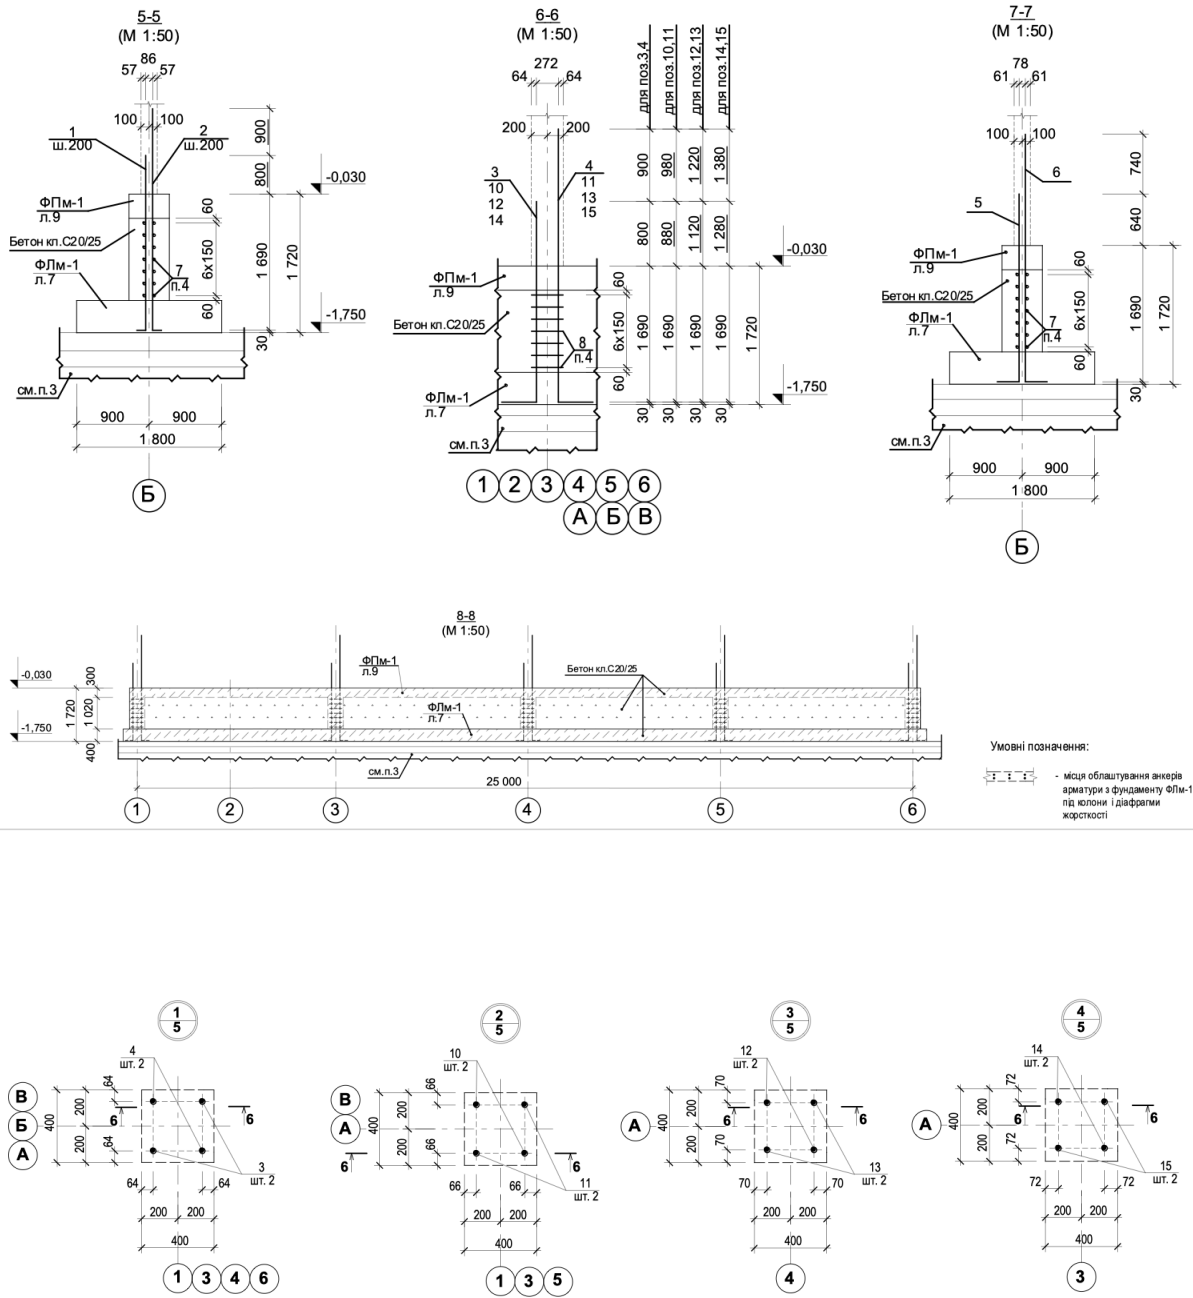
Розрізи 5-5, 6-6, 7-7, 8-8 до схеми розташування фундаментів
